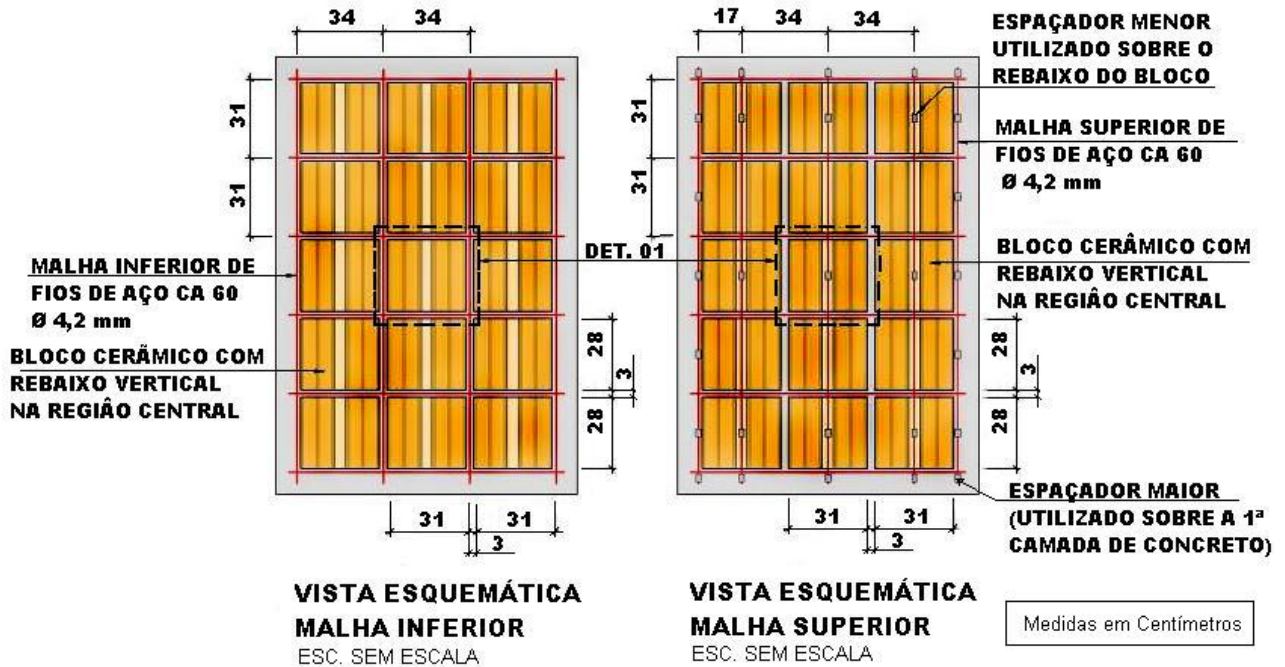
Vistas em planta de um painel (dimensões sem escala)
